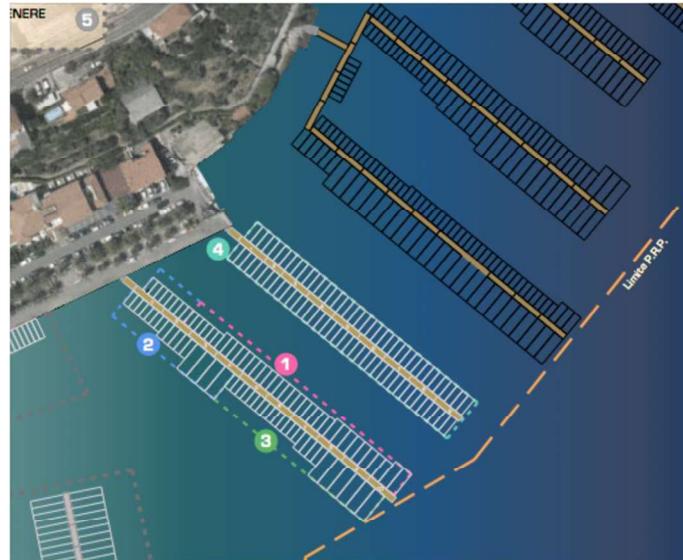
Soluzione progettuale finale (da Progetto\_Relazione Tecnica, Studio Architetto Roberto Evaristi).
